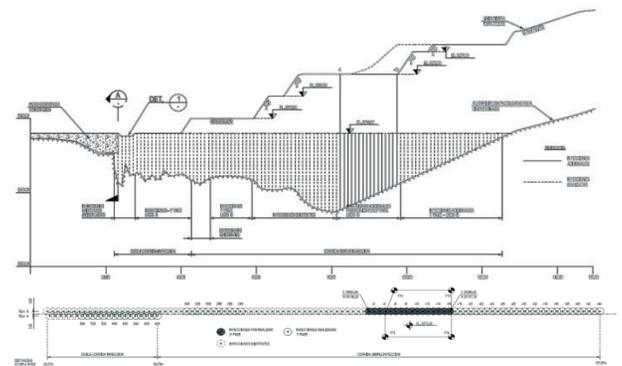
Vista en corte longitudinal y vista superior de la Cortina de Jet Grouting.
